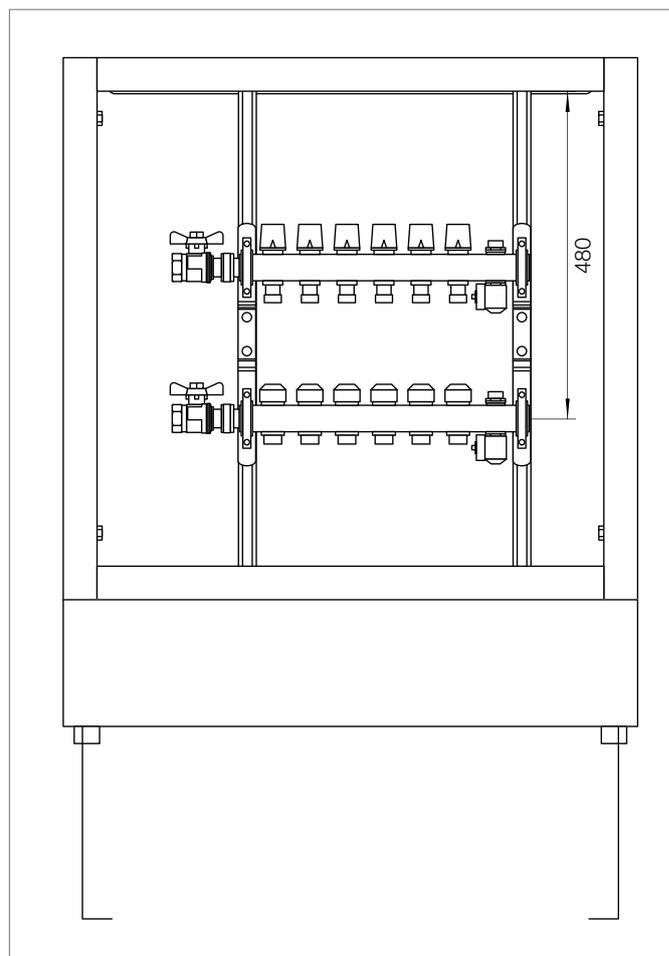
Hauteur de montage recommandée du collecteur de chauffage
